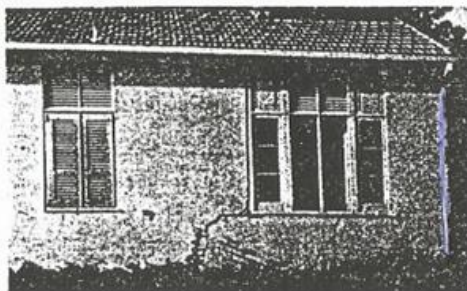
Imagens sobre o aparecimento de fissuras nas paredes da uma casa devido a fenómenos de expansão (Tschebotarioff, 1978)
